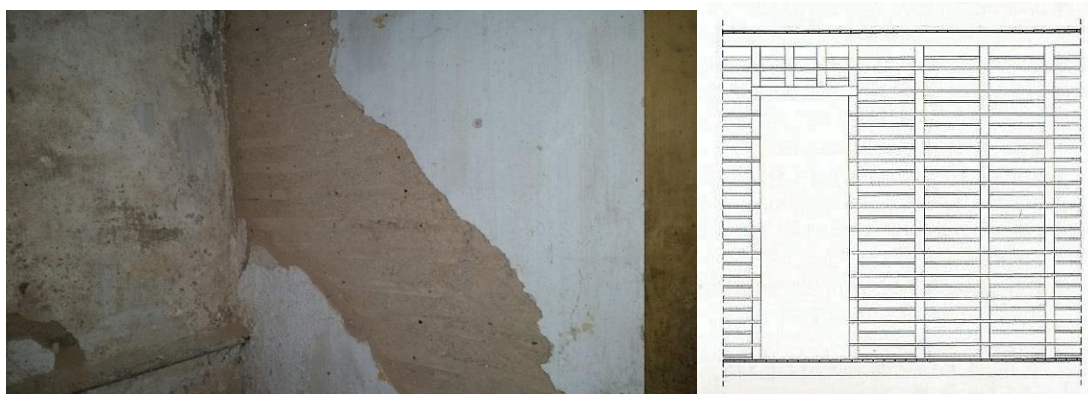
Parede em tabique com destaque do reboco e esquema de parede e tabique [70]
